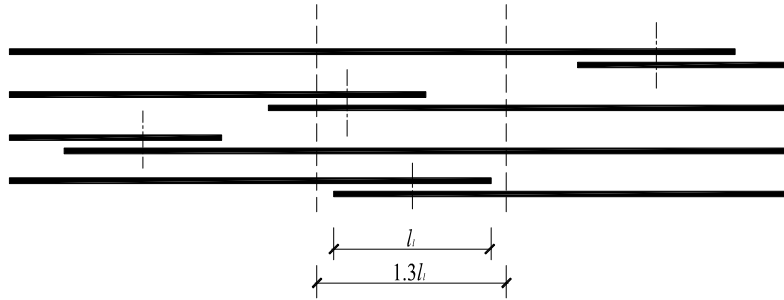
同一连接区段纵向受拉钢筋绑扎搭接接头
